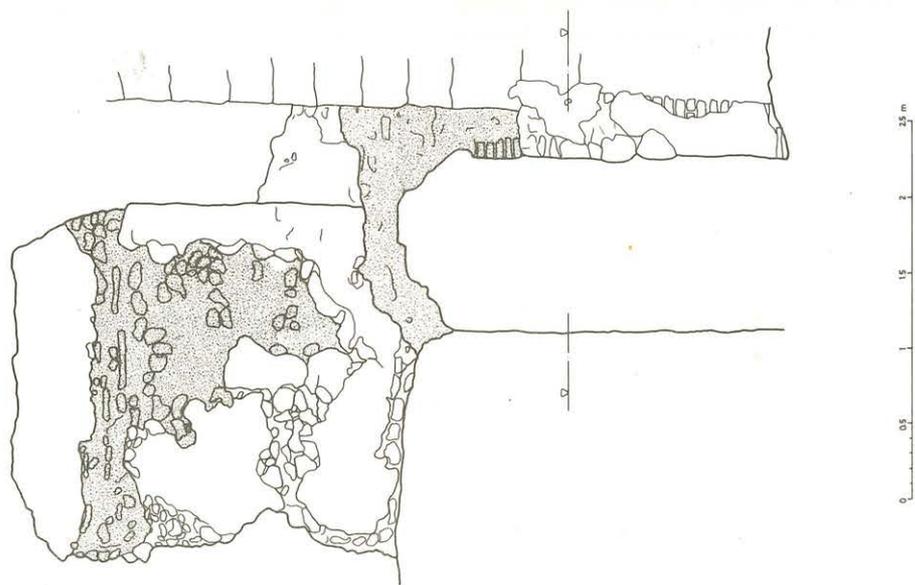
Alzado oeste de la puerta BB. 1. Ibidem autor.
